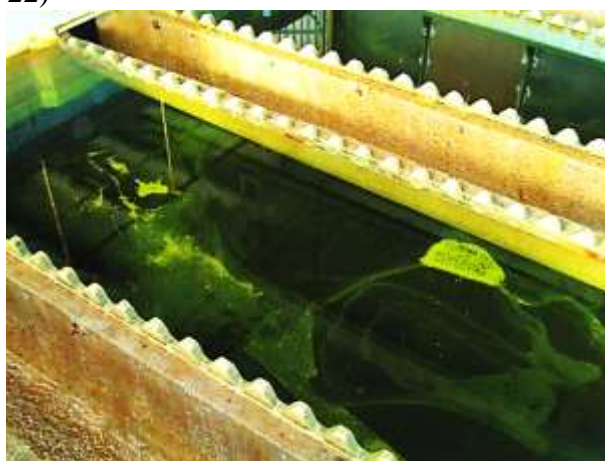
Визуальное обследование фильтровальной станции ОСВ (здание 22)
